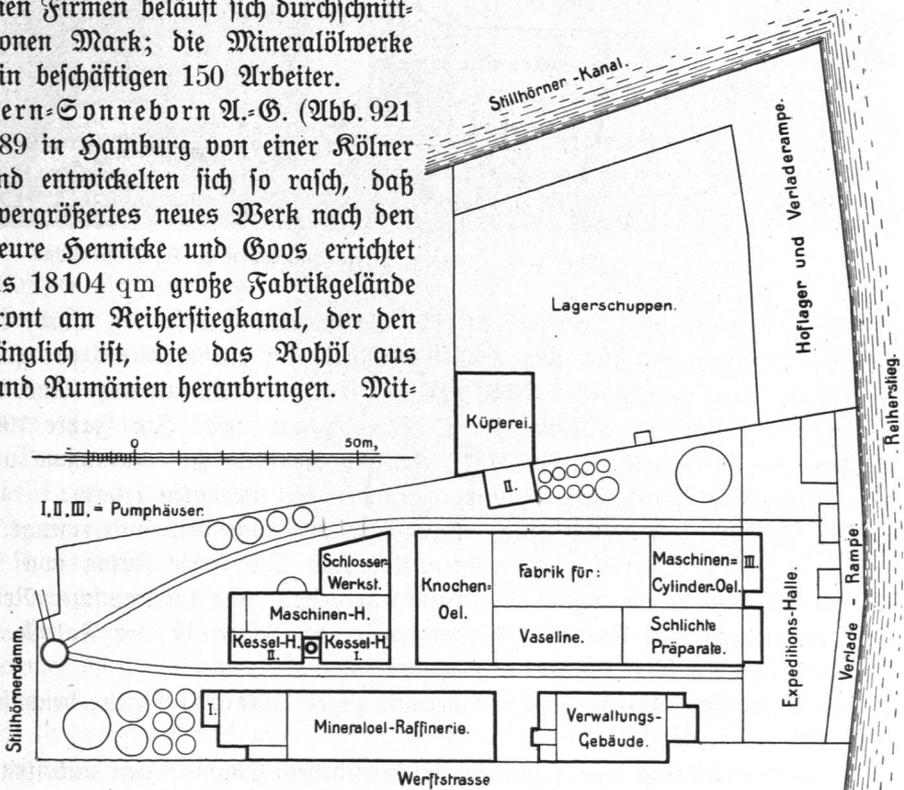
Ölwerke Stern-Sonneborn A.-G., Lageplan.
